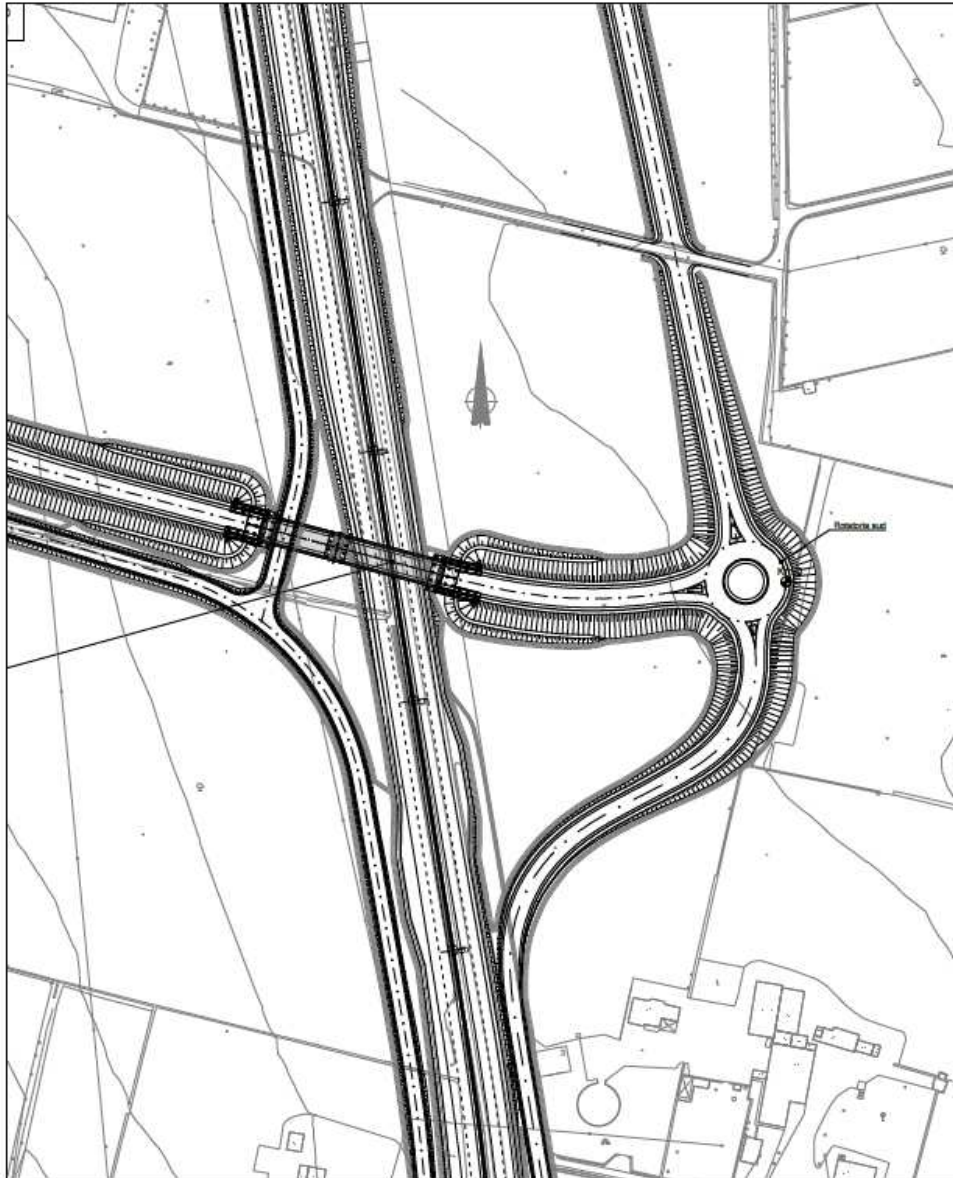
Planimetria Cavalcavia al Km 5+540
